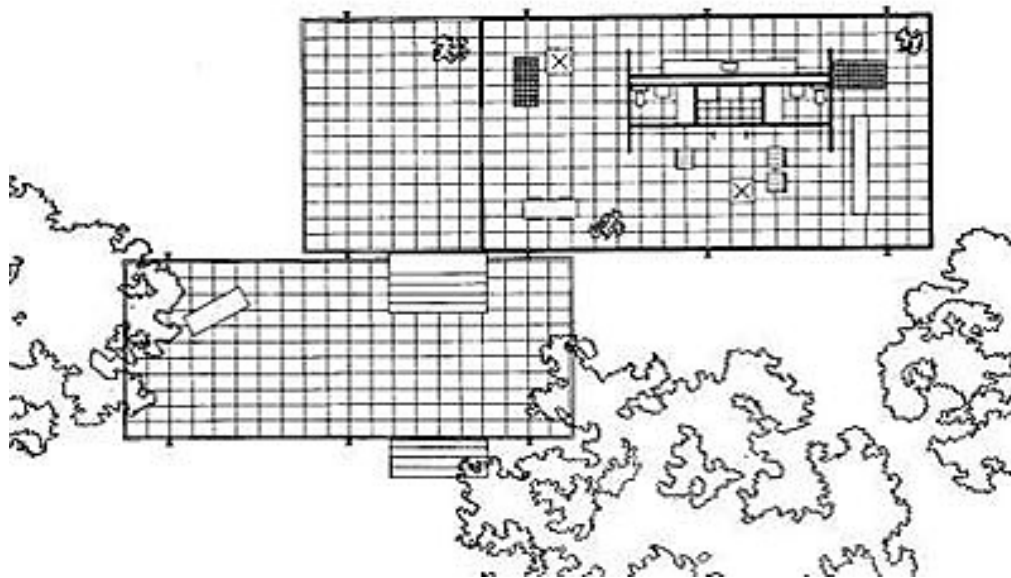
L. Mies van der Rohe, Farnsworth House, planimetria
